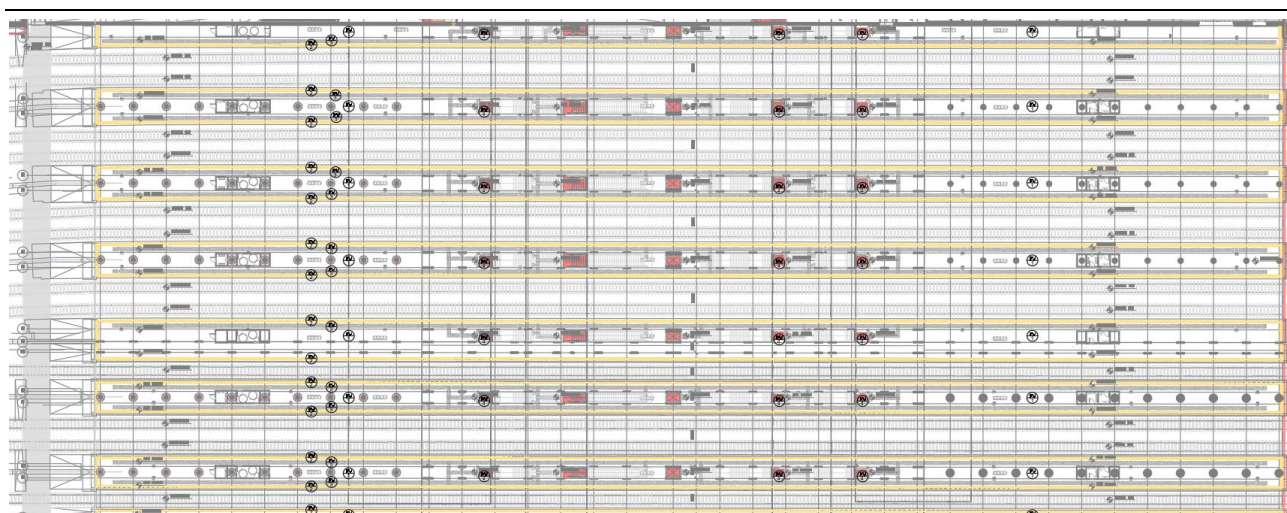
Stralcio Planimetria percorsi tattili Banchine
